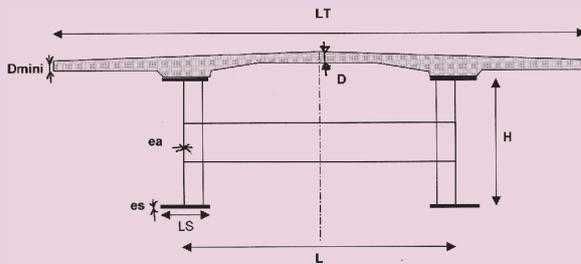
Paramètres du dimensionnement d'un bipoutre à entretoises
